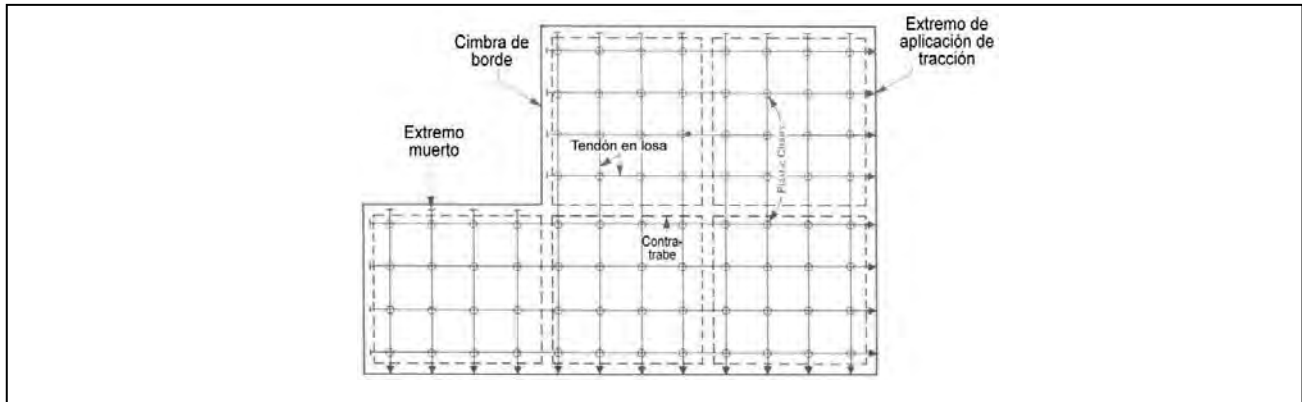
EJEMPLO DE POSICIONAMIENTO DE TENDONES DE PRESFUERZO EN UNA LOSA DE CIMENTACIÓN POSTENSADA
